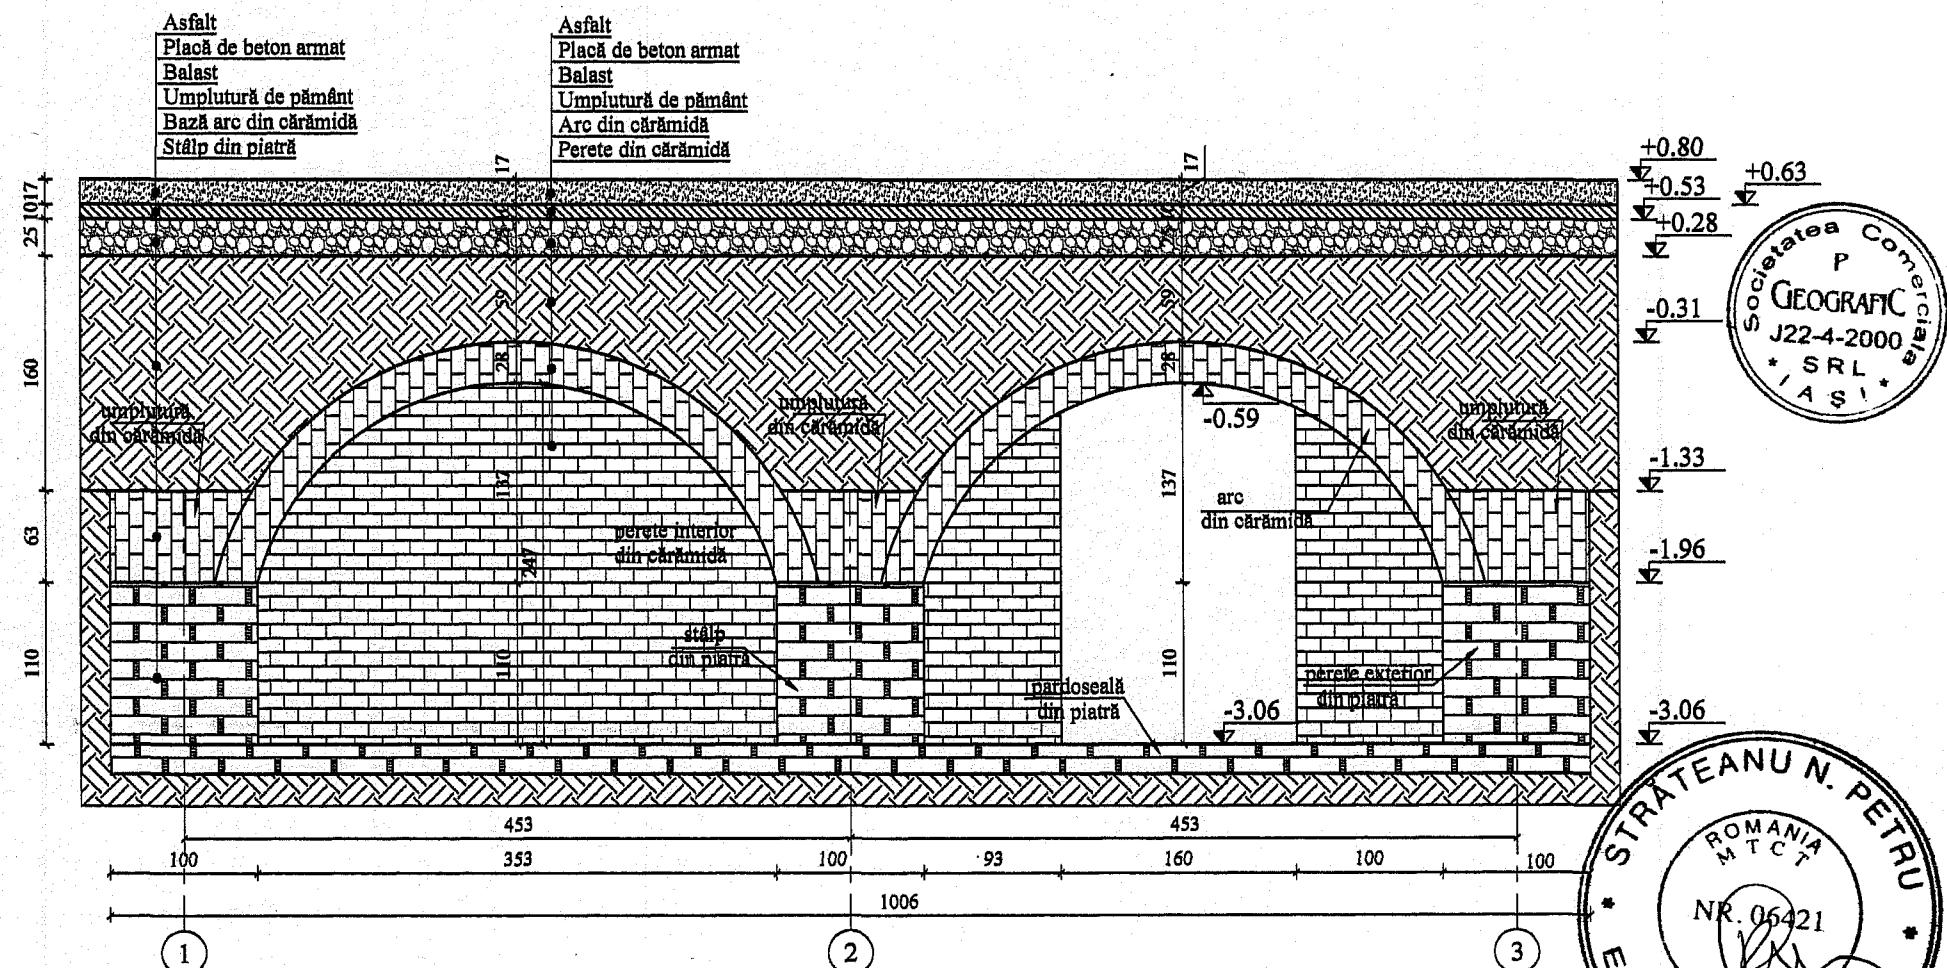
SECȚIUNE TRANSVERSALĂ $B-B$ - SITUAȚIE EXISTENTĂ
